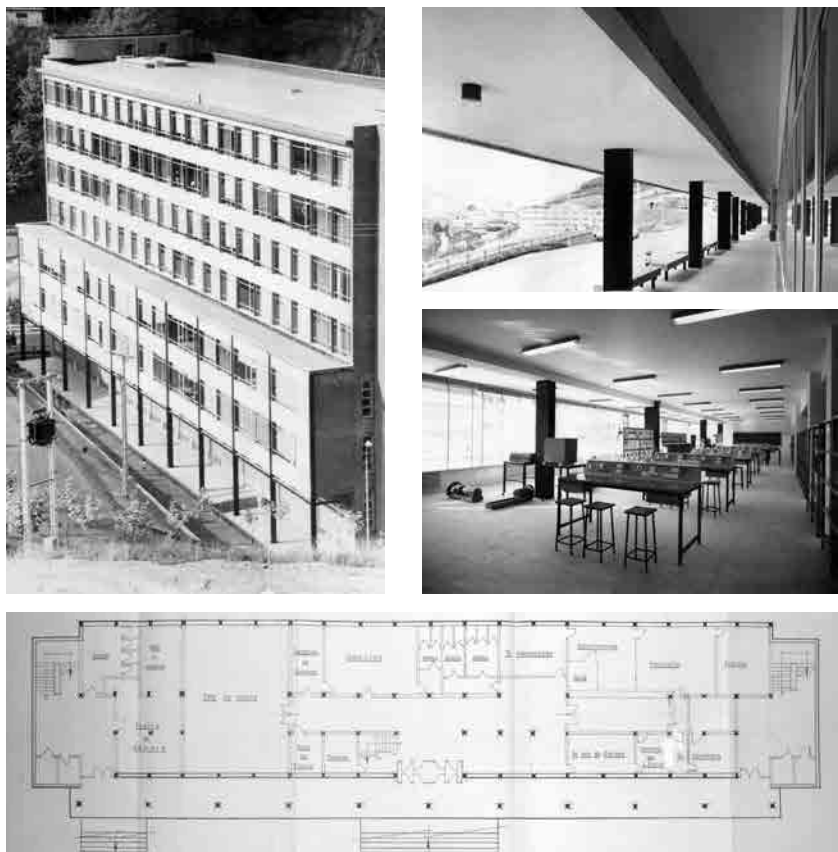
, Fig. 6, Fig. 7 y Fig. 8 Edificio docente. Vista general de la fachada Sur o trasera (arriba izquierda), vista del porche de la fachada Norte (arriba derecha), vista del interior de un taller (centro derecha) y planta baja (abajo). Fotografías de época.
